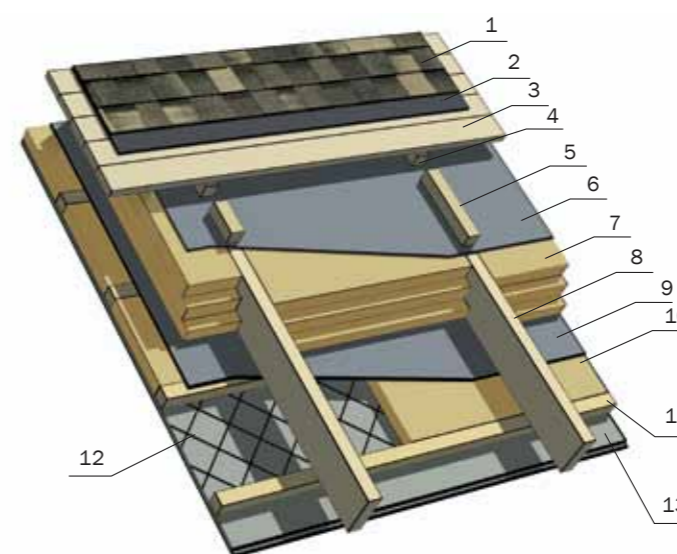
Конструкция кровельной системы ТН-ШИНГЛАС Классик с железобетонными несущими конструкциями и крупнощитовым настилом
